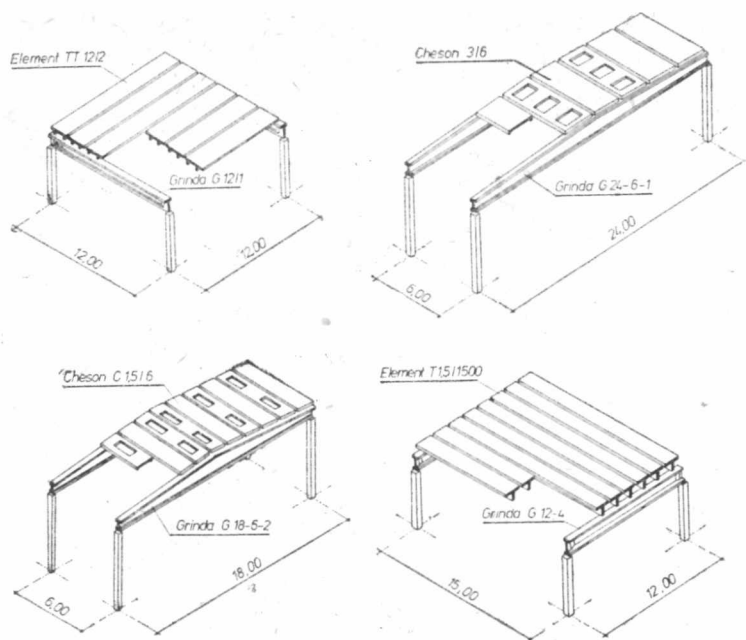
b. Hale parter din grinzi și elemente de suprafață prefabricate plane.
